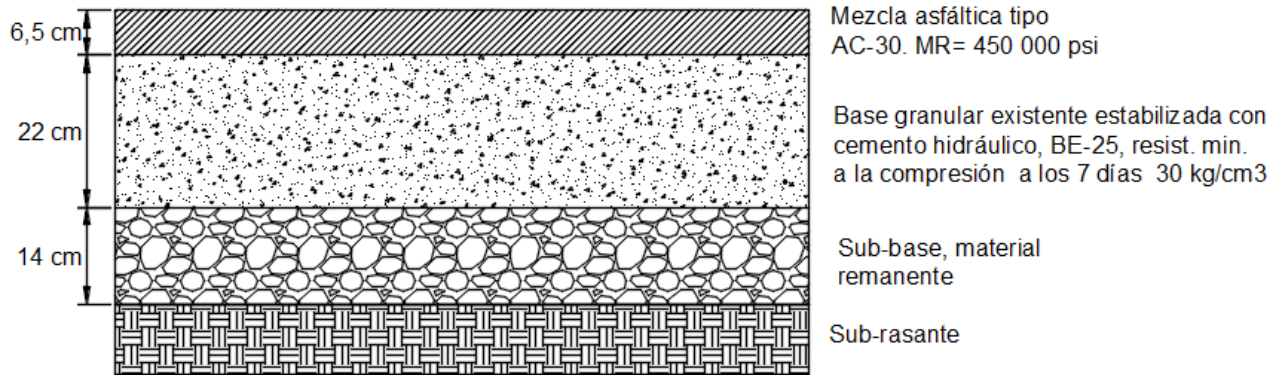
Perfil de la estructura de pavimento propuesta para el TH=38.
